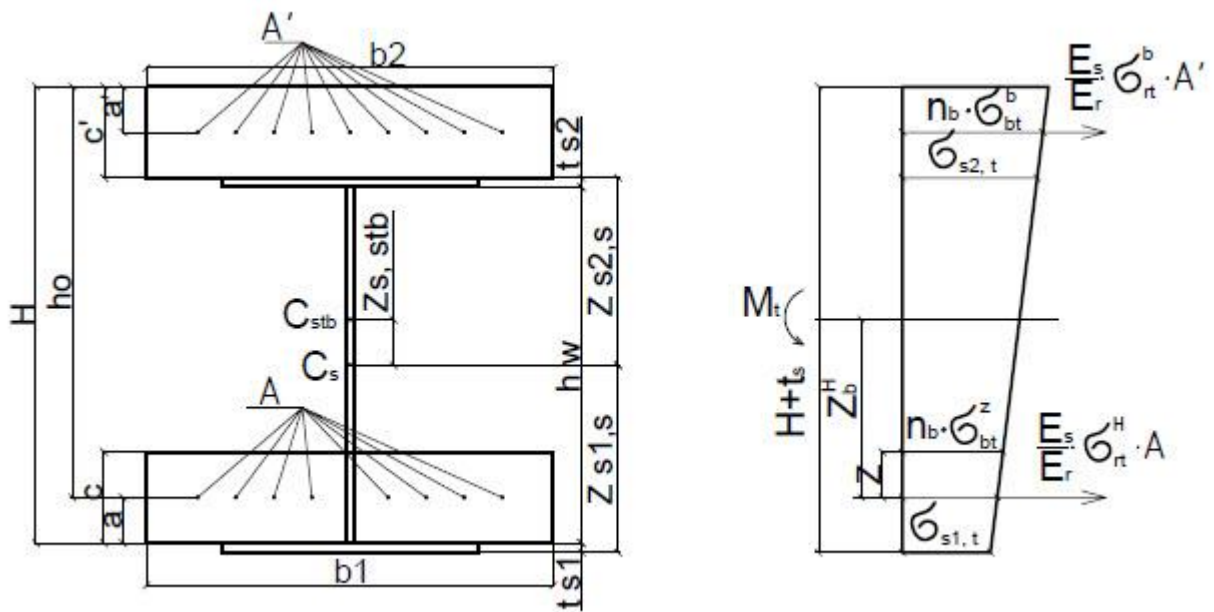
Напруження в металевій балці, яка об'єднана з двома залізобетонними плитами.
